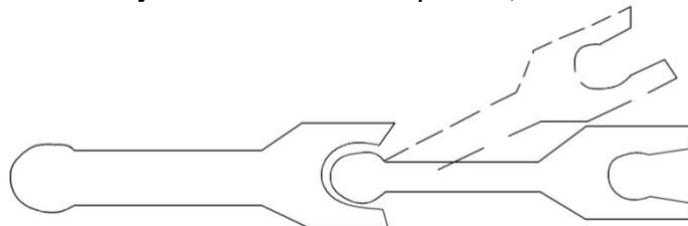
Железобетонный шпунт для криволинейных участков
